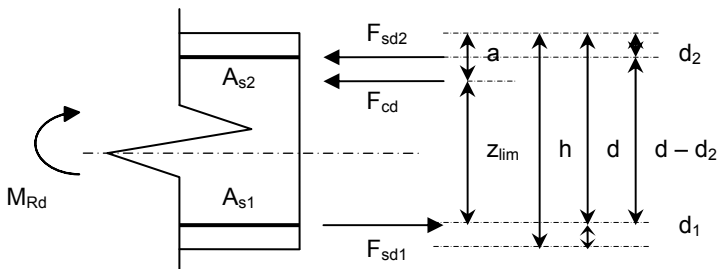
Rechteckquerschnitt mit Druckbewehrung unter reiner Biegung
